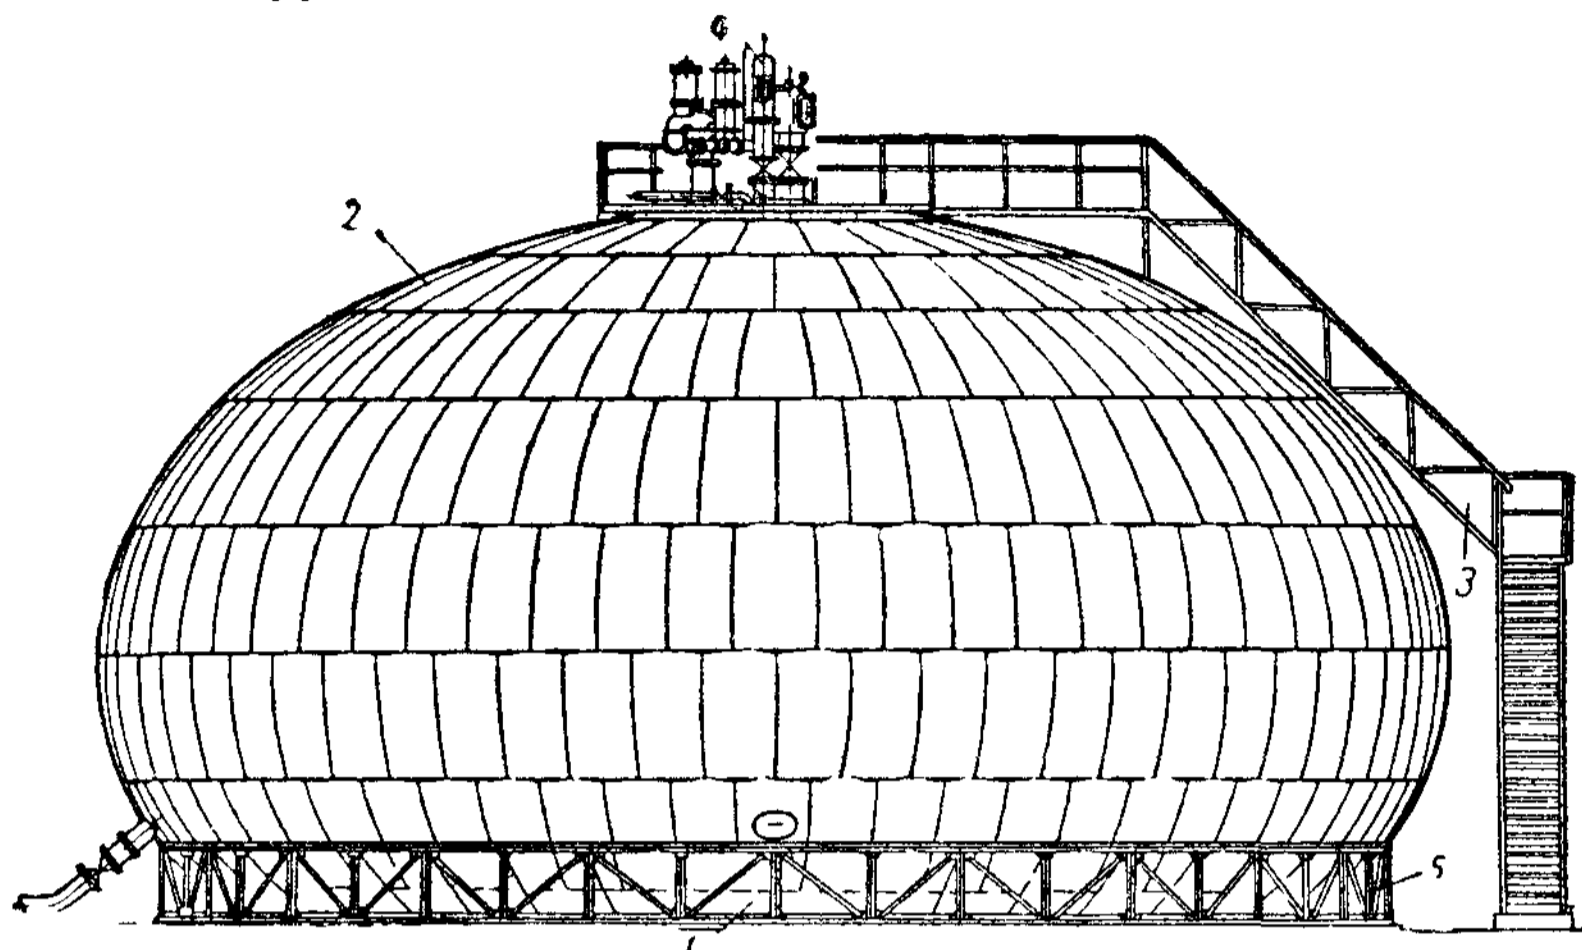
Каплевидный резервуар с опорным кольцом
